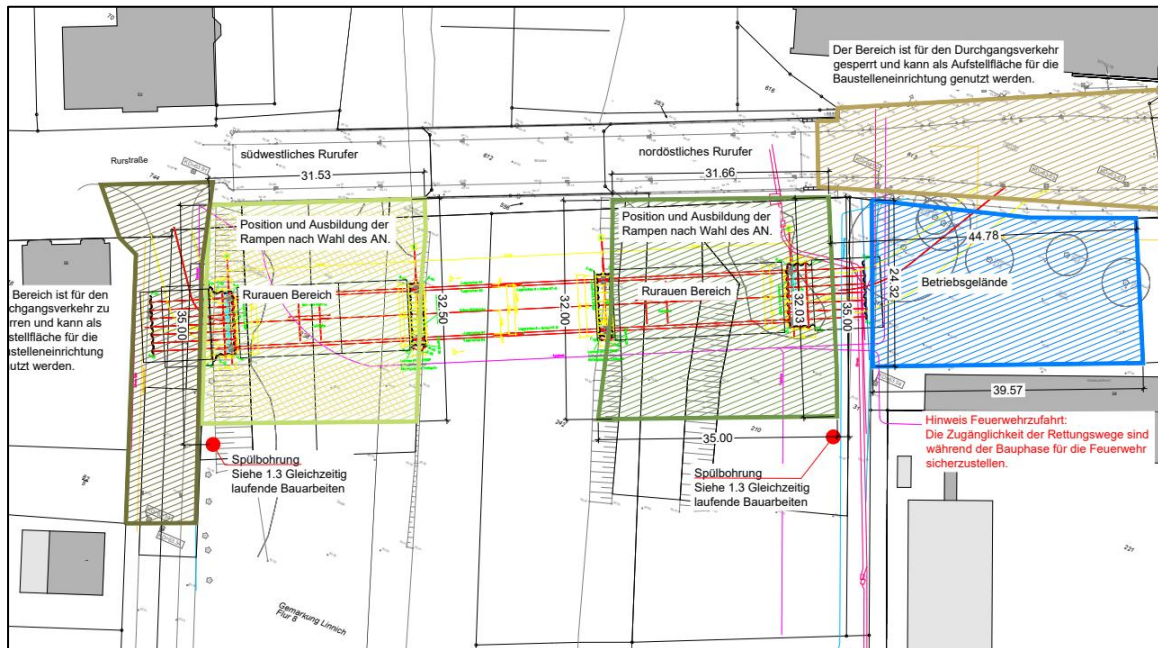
Plan der Ersatzbrücke mit Eingriffsflächen.
